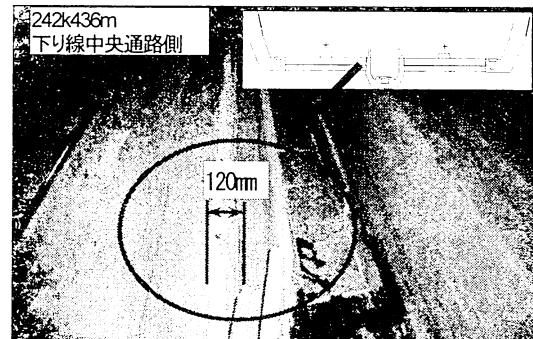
下り線路盤コンクリートと中央通路部の開口状況
